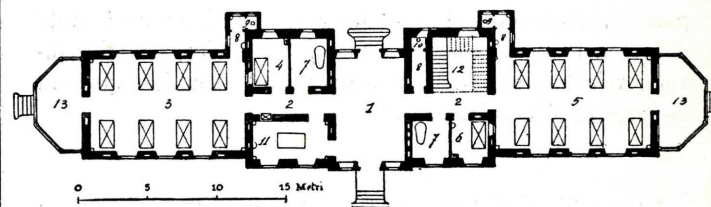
Pianta dell'Ospedaletto di Pont Canavese.
